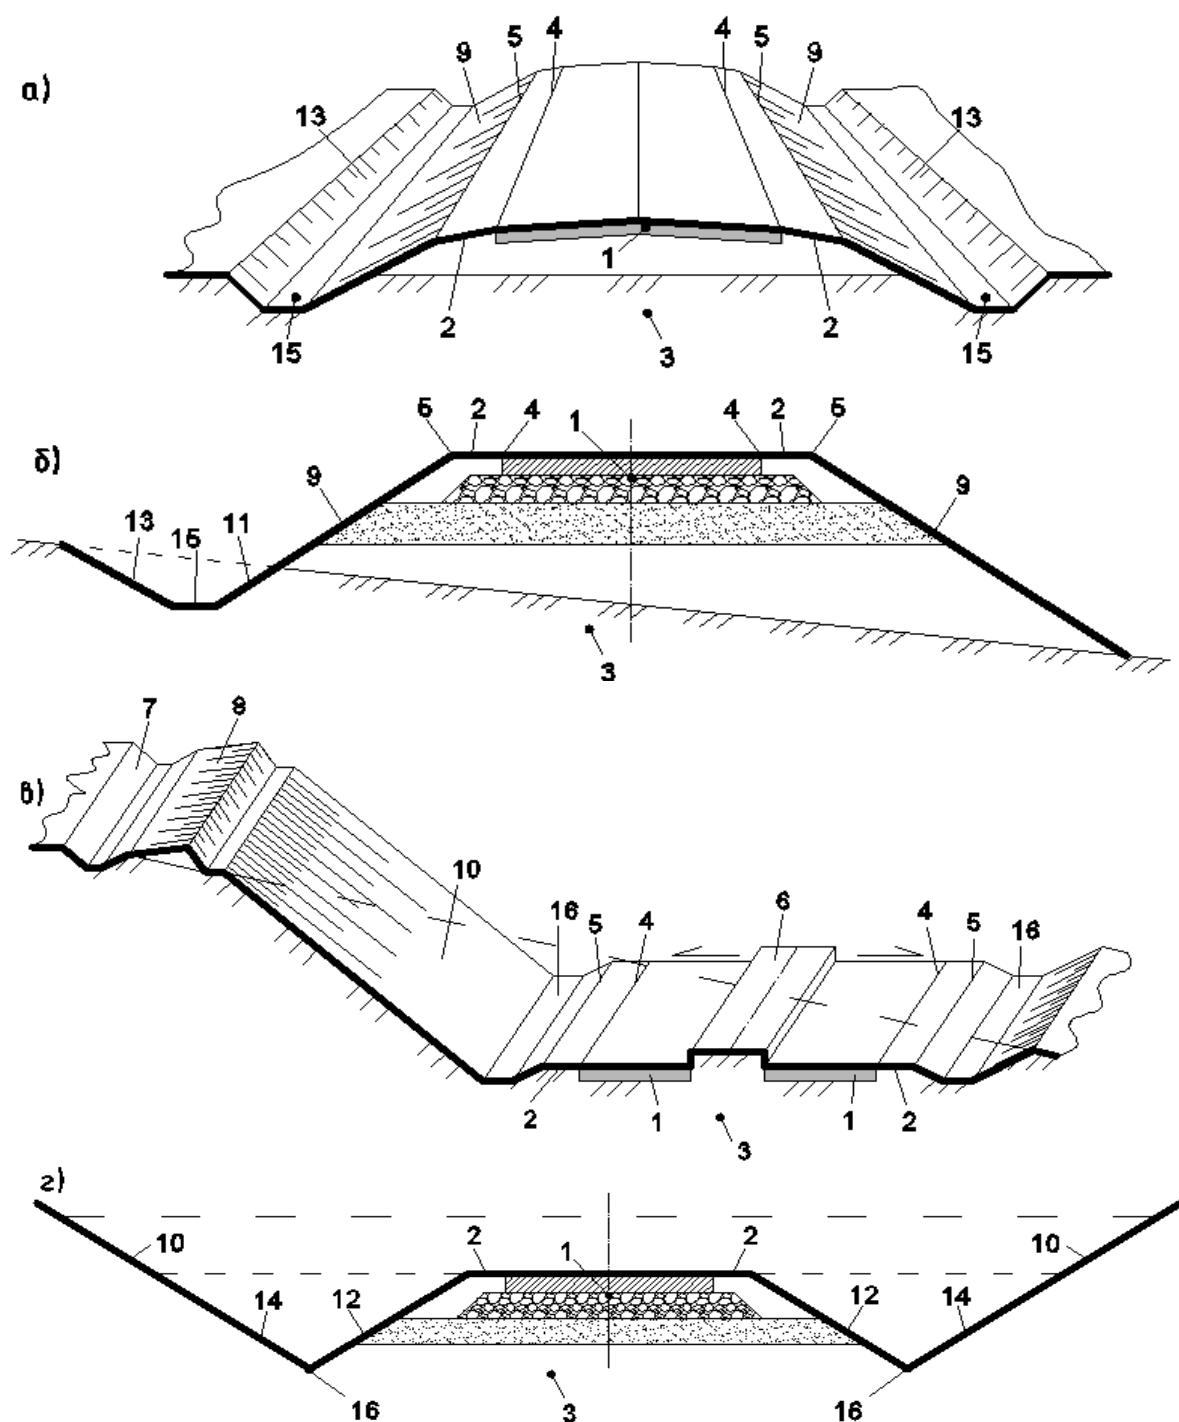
Основные элементы автомобильной дороги: а) насыпь с водоотводными трапецидальными канавами; б) поперечный профиль насыпи с канавой с нагорной стороны; в) выемка на косогоре с трапецидальными кюветами, банкетом и забанкетной канавой, г) выемка с треугольными кюветами. 1 – дорожная одежда; 2 – обочины; 3 – основание земляного полотна; 4 – кромка проезжей части; 5 – бровка земляного полотна; 6 – разделительная полоса; 7 –забанкетная (нагорная) канава; 8 – банкет; 9 – откос насыпи; 10 – откос выемки; 11 – внутренний откос канавы; 12 – внутренний откос кювета; 13 – внешний откос канавы; 14 – внешний откос кювета; 15 – дно канавы; 16 – дно кювета.
